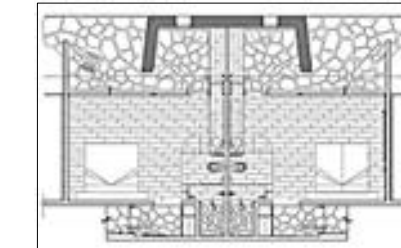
PLANTA HABITACIÓN PONIENTE
